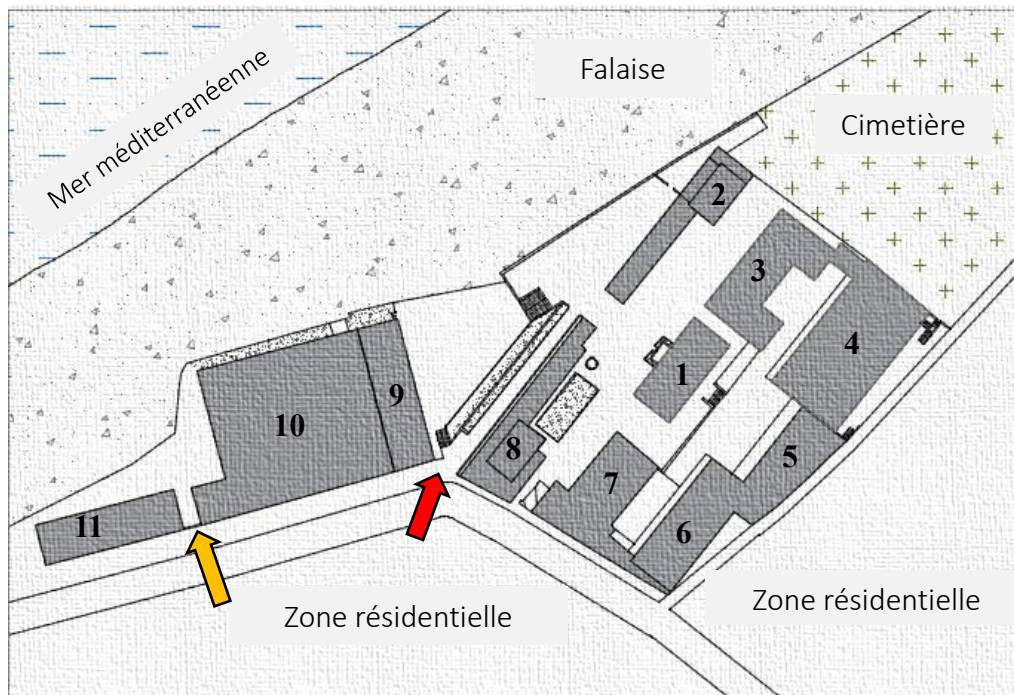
Plan de masse du LTE - Source : BET chargé de restauration, traité par auteur
